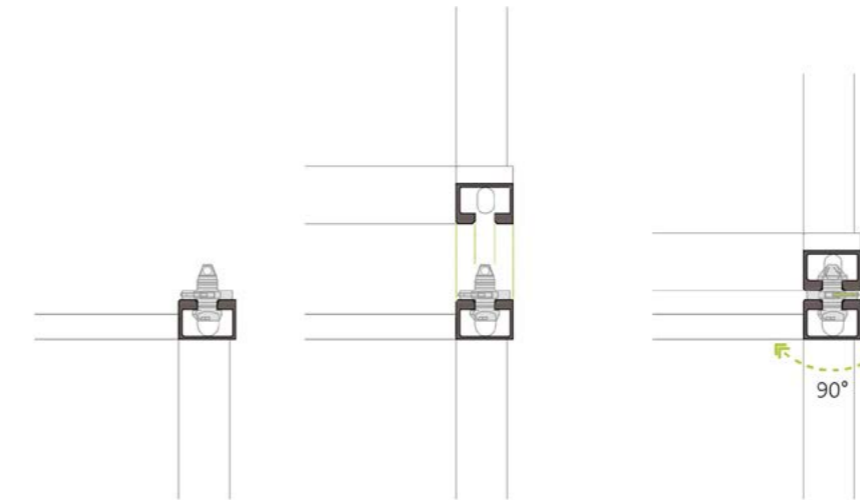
Dettaglio fissaggio verticale tra moduli in acciaio.
